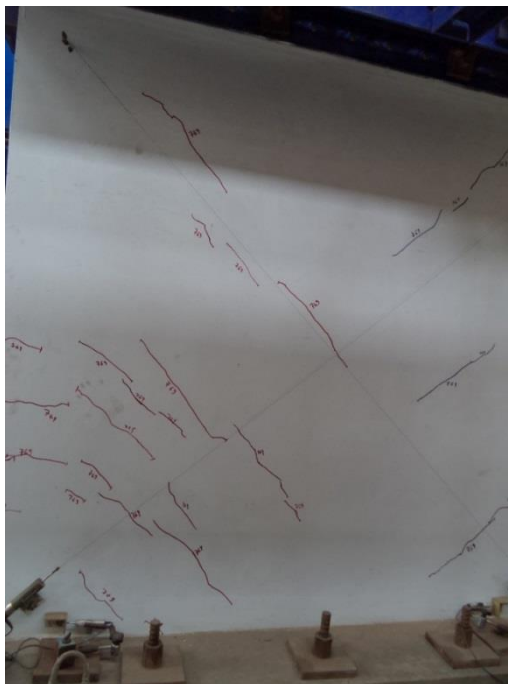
Concentración de las grietas cercanas a la base de las columnas de confinamiento
